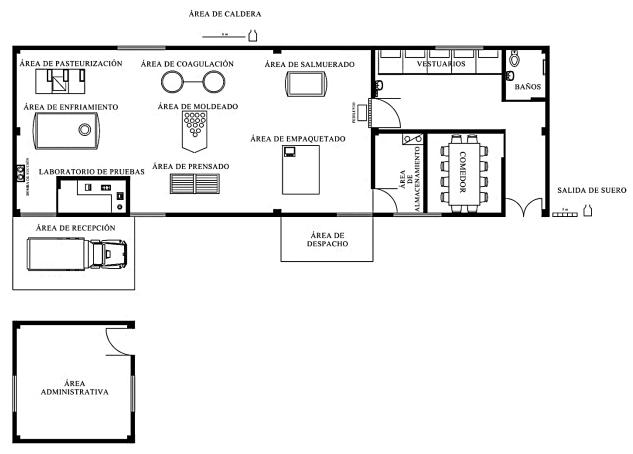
Distribución de la planta propuesta para la empresa El Va´Quero
